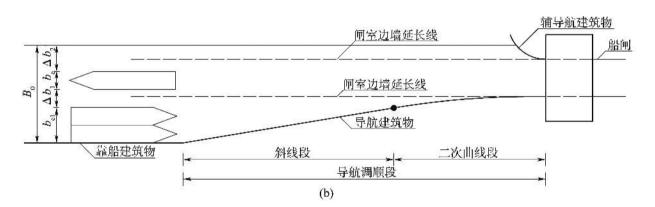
导航、靠船建筑物平面布置形式示意图
